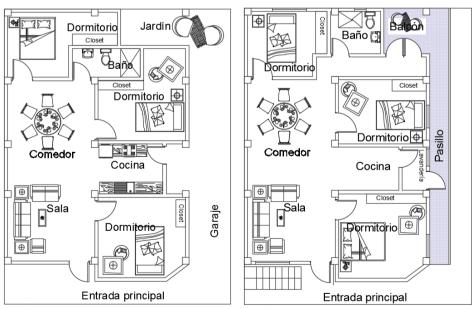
Plano arquitectónico P.A.V.2 Fuente: Propia
